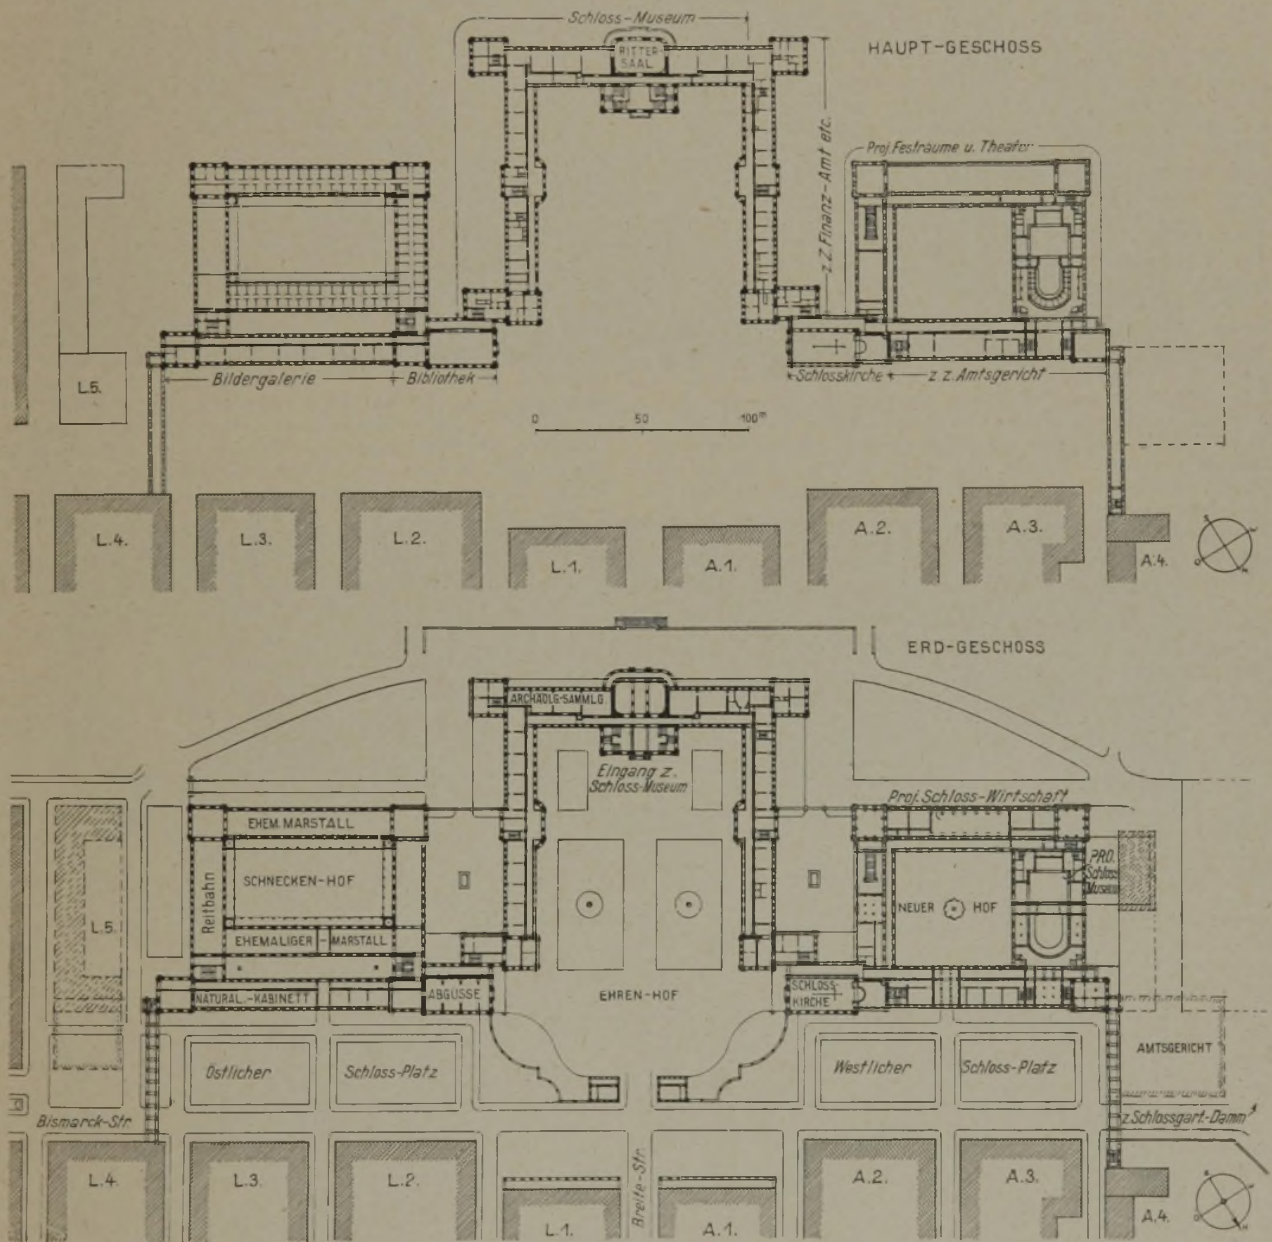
u. 6. Grundrisse mit ergänzten Westflügeln und Verbindungsbauten. (1 : 3500.)
